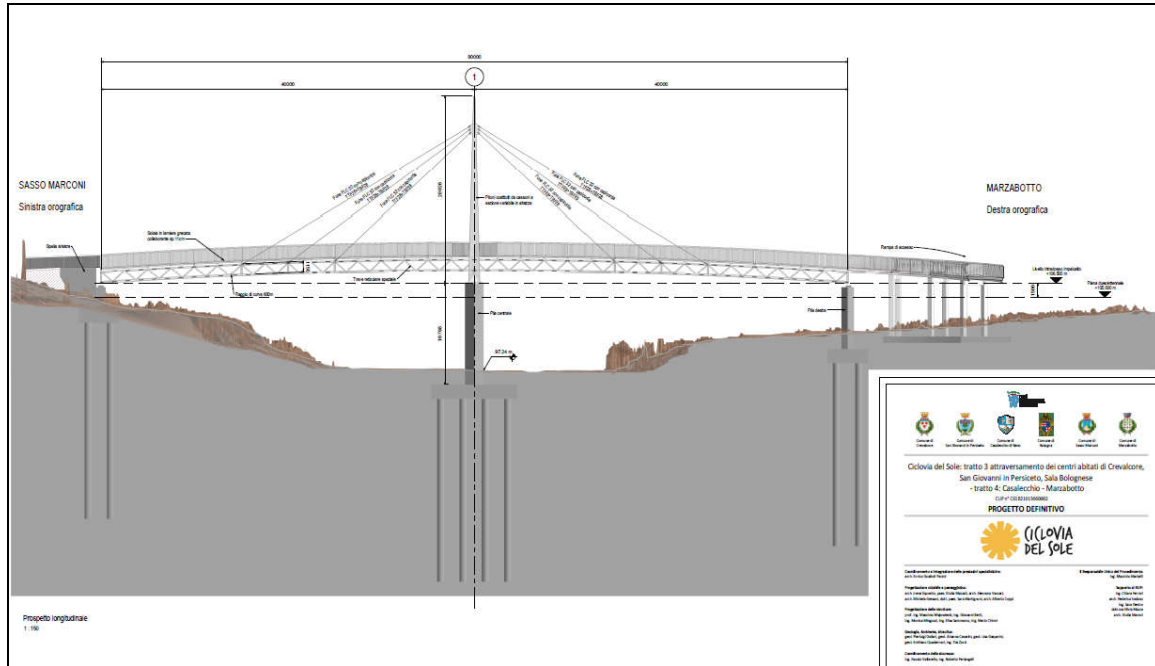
Fiume Reno – vista prospettica della passerella in acciaio
